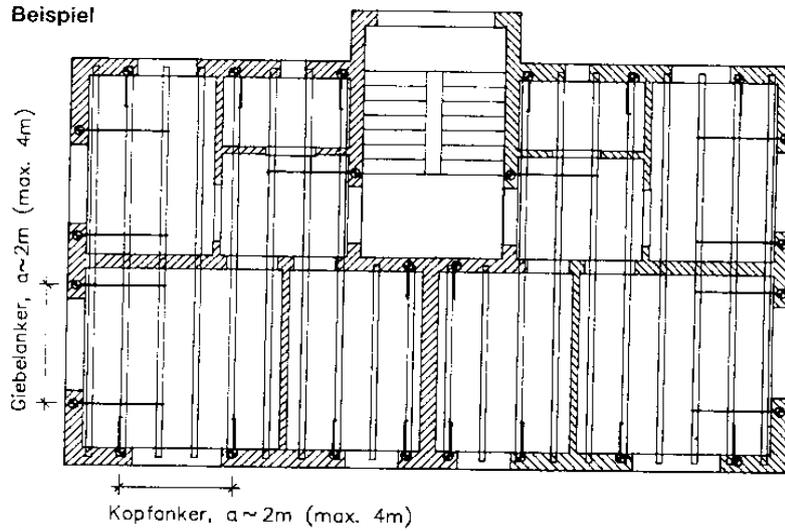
Grundrißdarstellung; Verankerung der Umfassungswände mit Zugankern an Holzbalkendecken herkömmlicher Bauart
